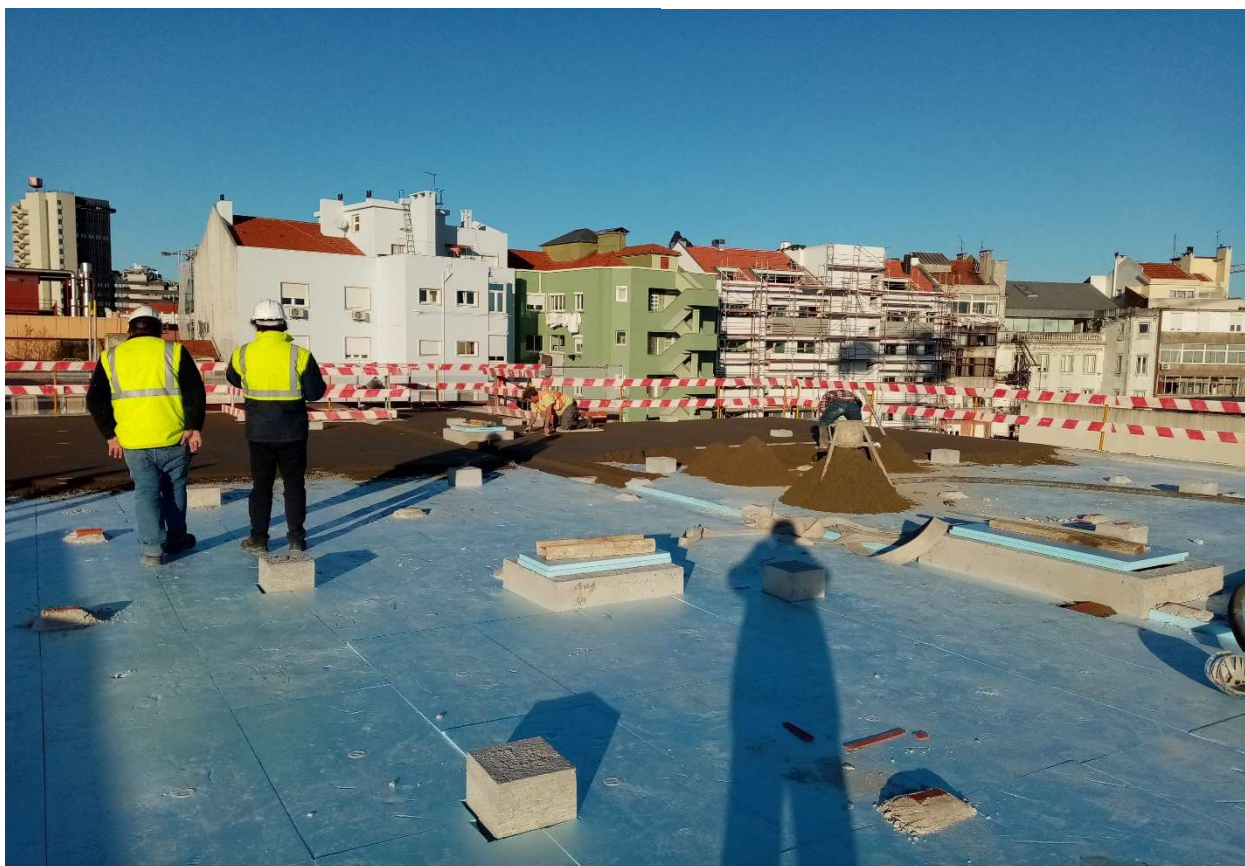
Colocação de XPS e execução de betonilha na cobertura
